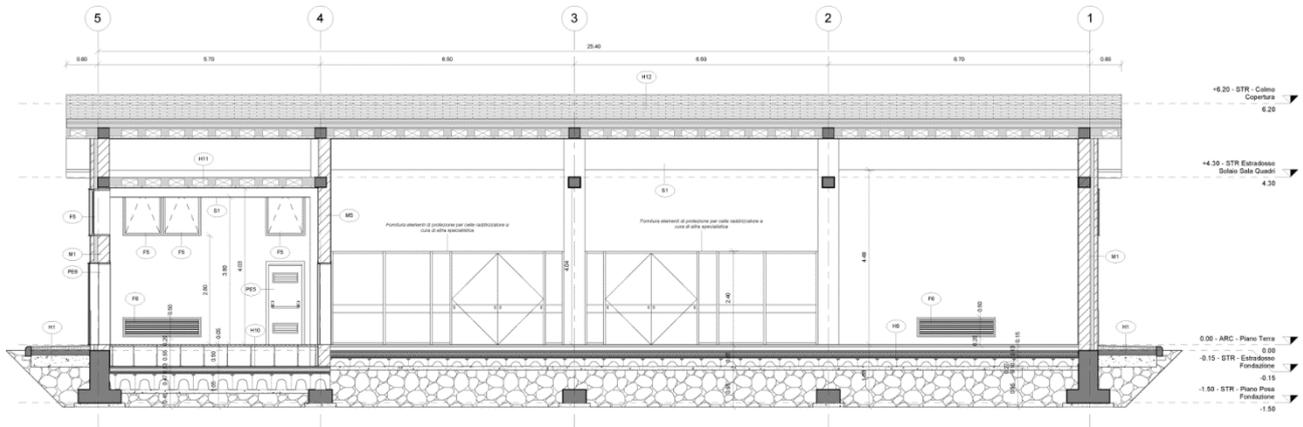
SSE Pieve Emanuele - Sezione C – C
